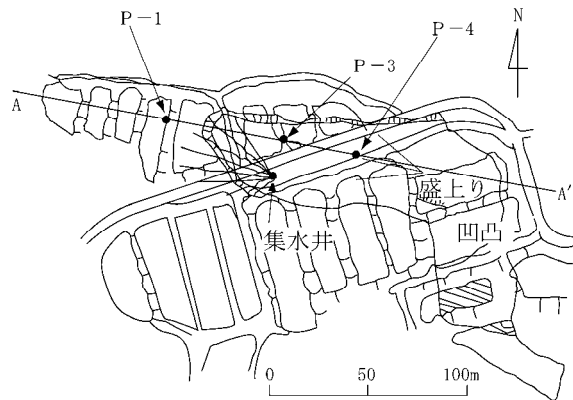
「越地すべり」平面図と集水井、間隙水圧計(P-1～P-4)などの位置
